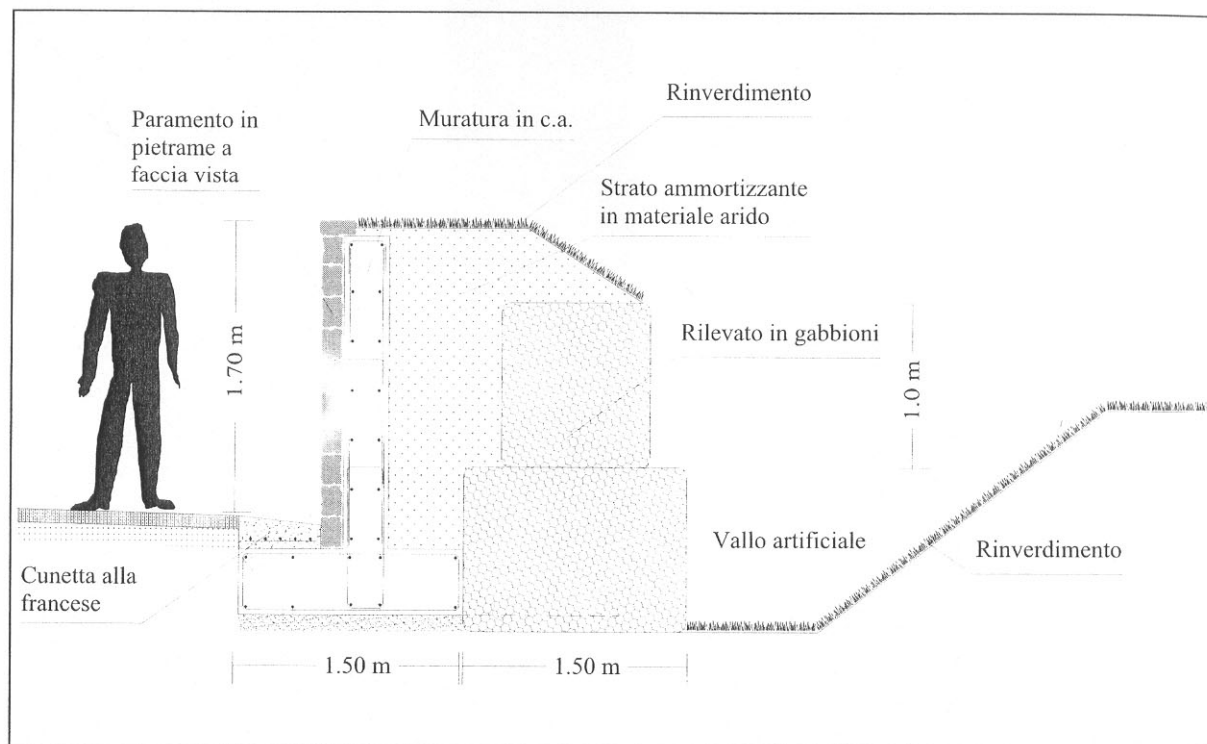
Sezione trasversale del sistema muro-rilevato previsto
